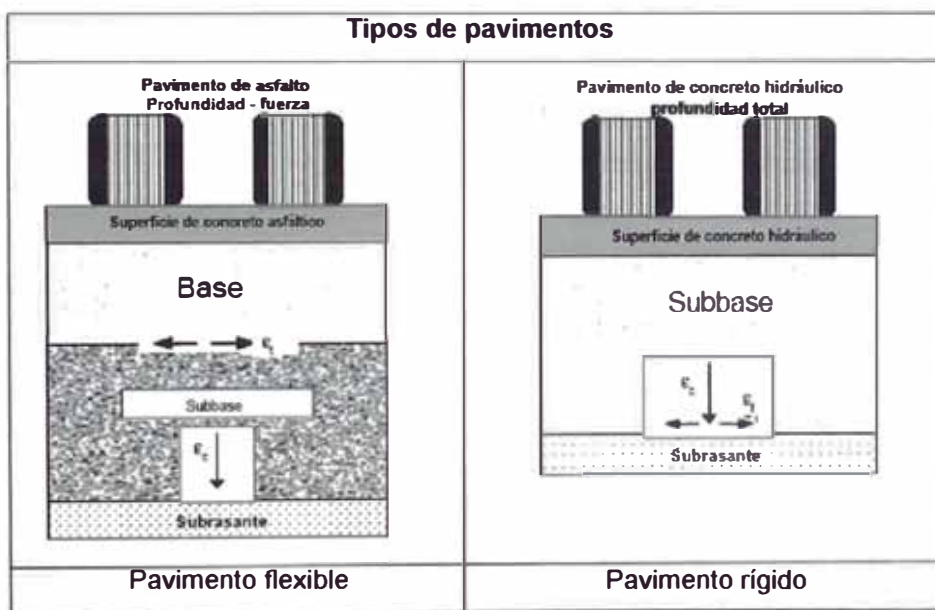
Tipos de pavimentos: flexible-rígido
